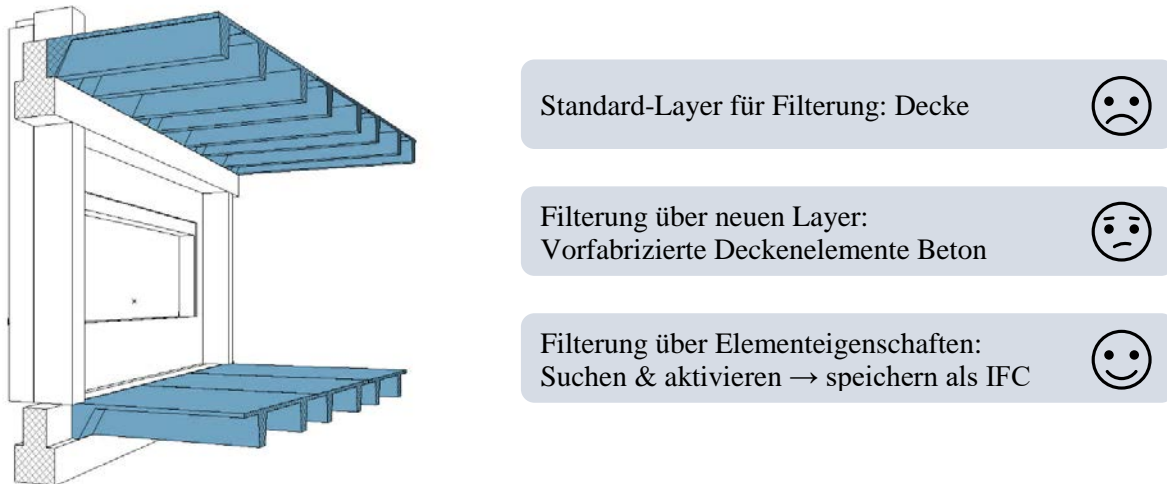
Filterungsvarianten für die Isolierung der Betonelemente
